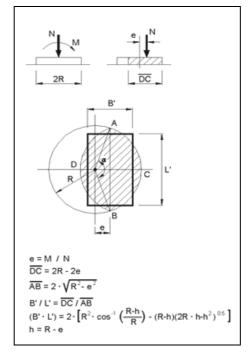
Fondazione efficace equivalente (Meyerhof, 1953)
